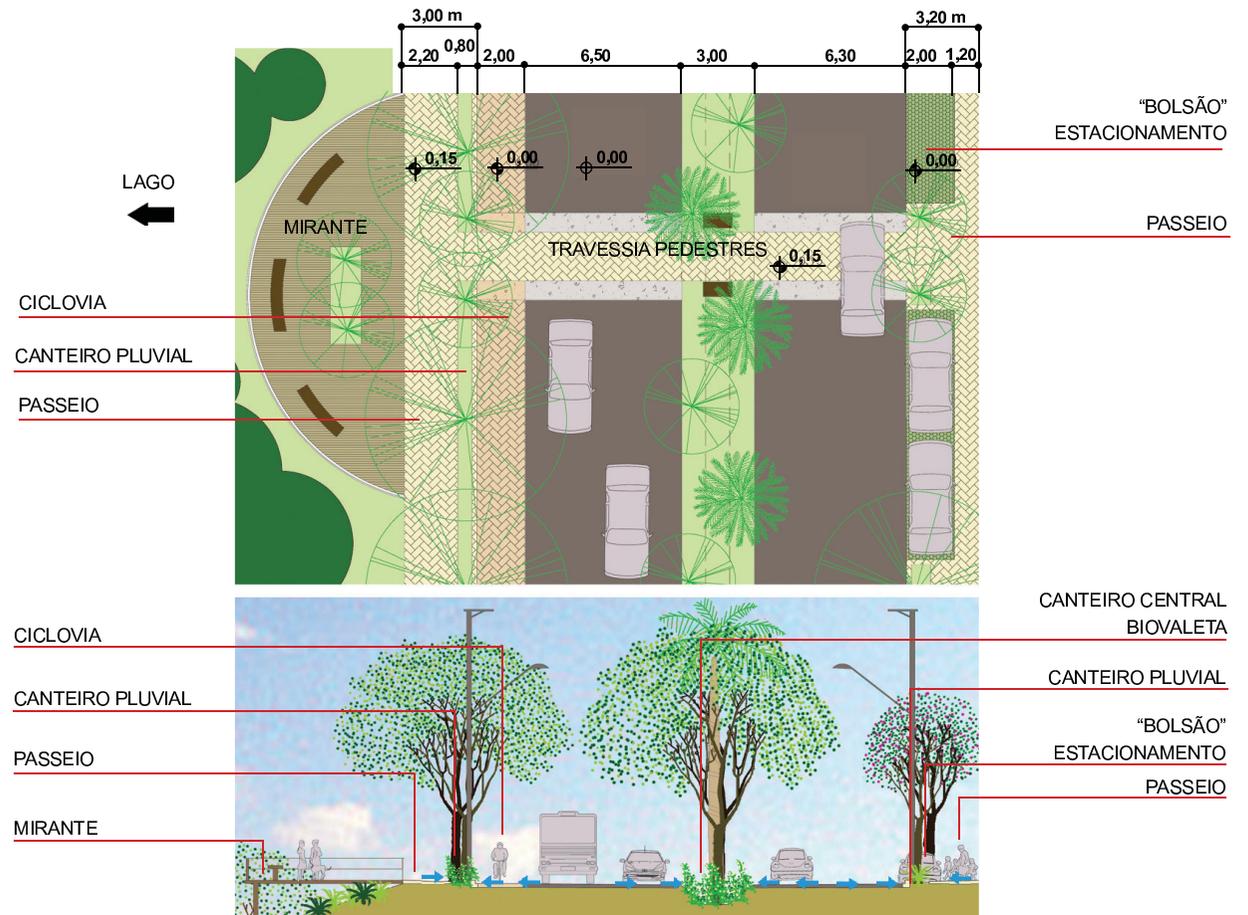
Avenida Tancredo Neves (Eixo articulado da Sede) - trecho com canteiro central - proposta
